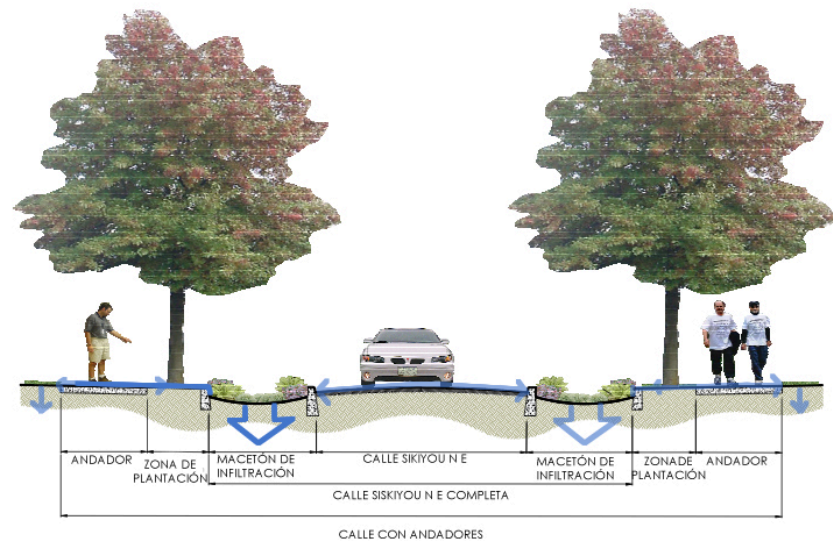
Planta de calle Siskiyou Noreste, Portland.
